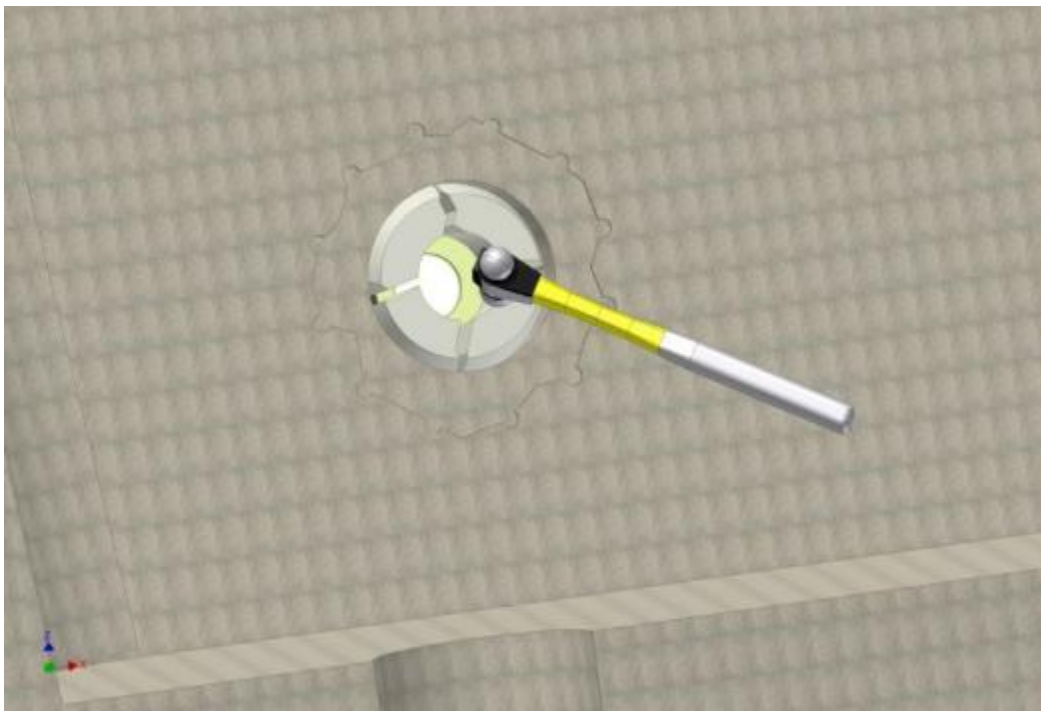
Je nach Beschädigung kann der Block mit Handwerkzeugen entfernt werden.
